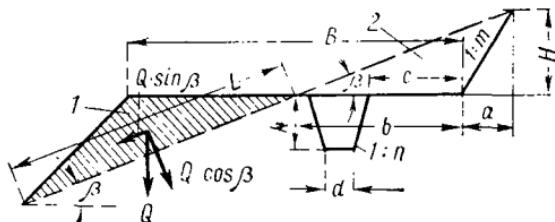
Расчетная схема устойчивости насыпи на косогорах:
